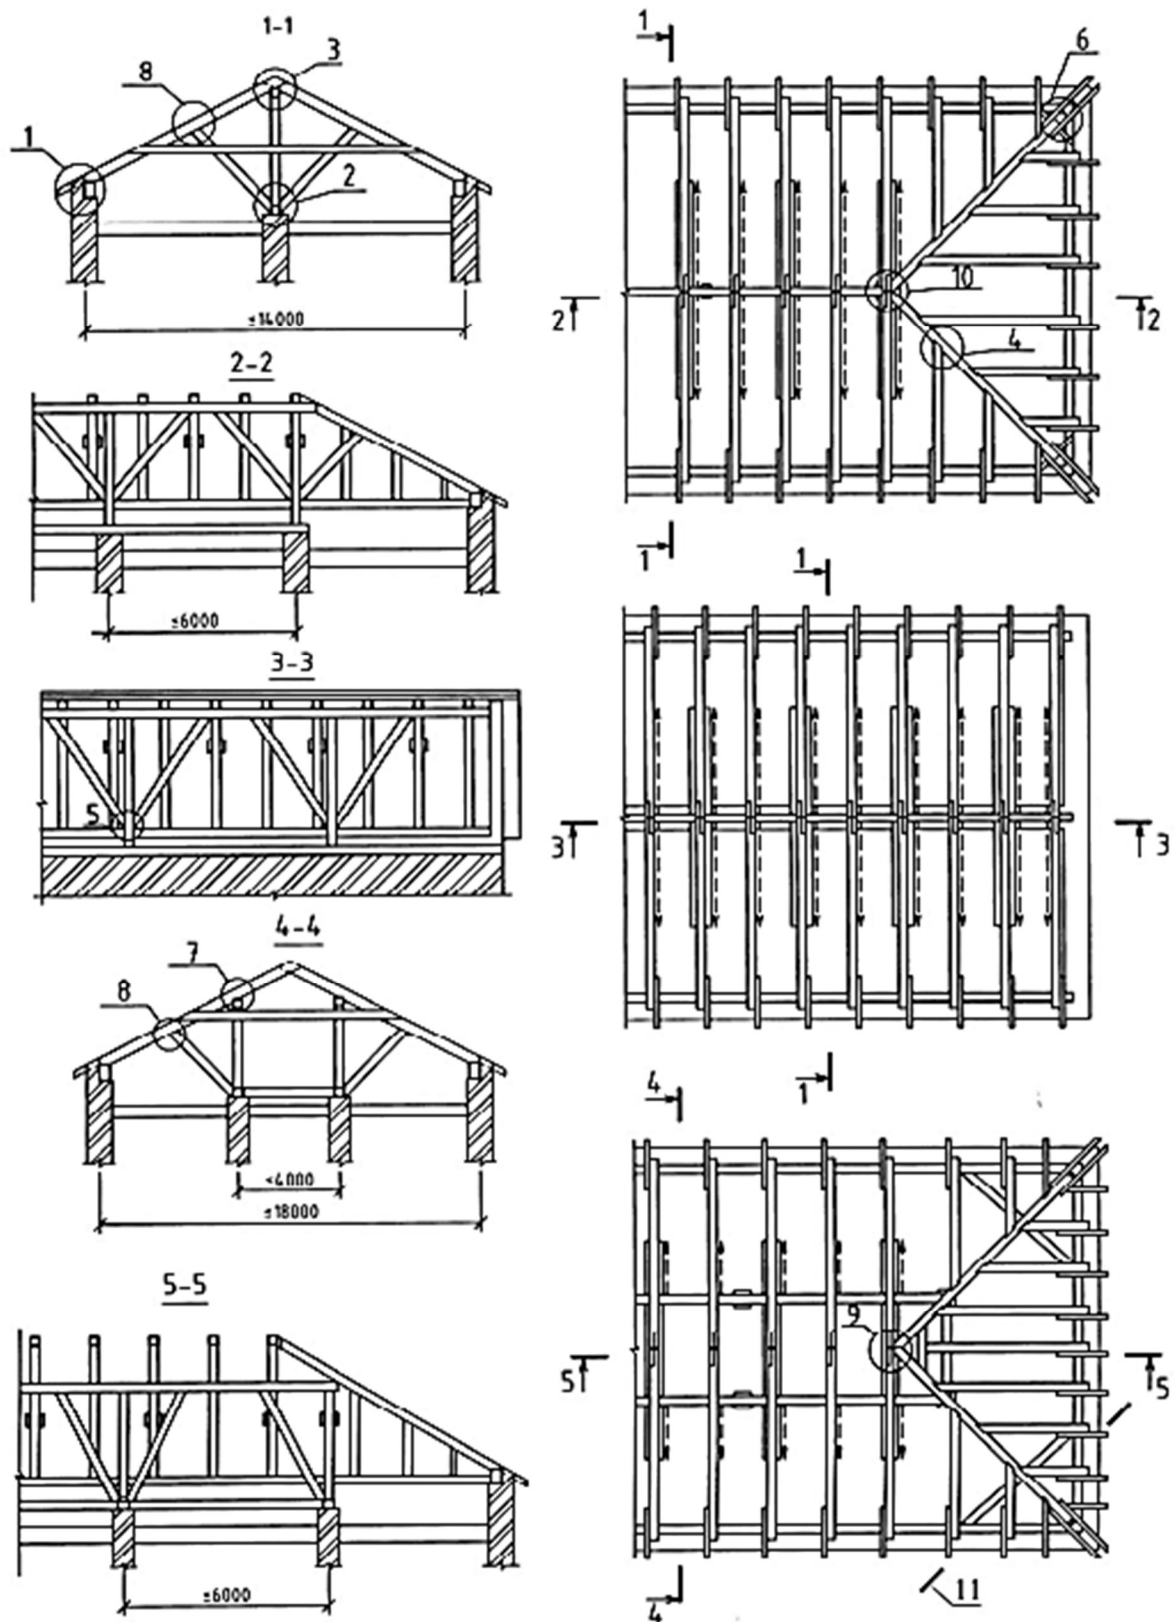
Планы и разрезы крыши с наслонными стропилами
